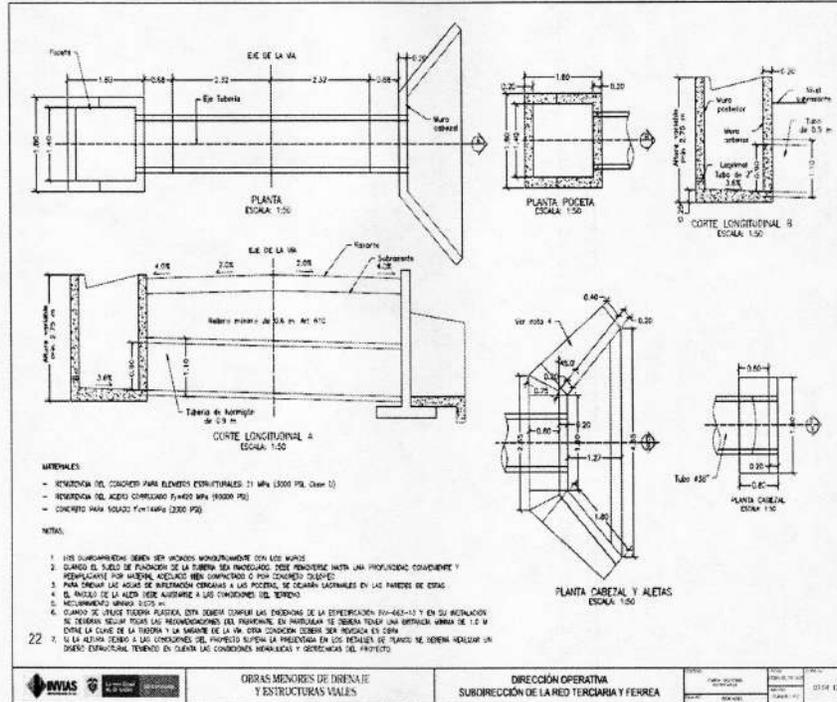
Planta Secciones Alcantarilla en tubería – Fuente: Municipio de Curumani
